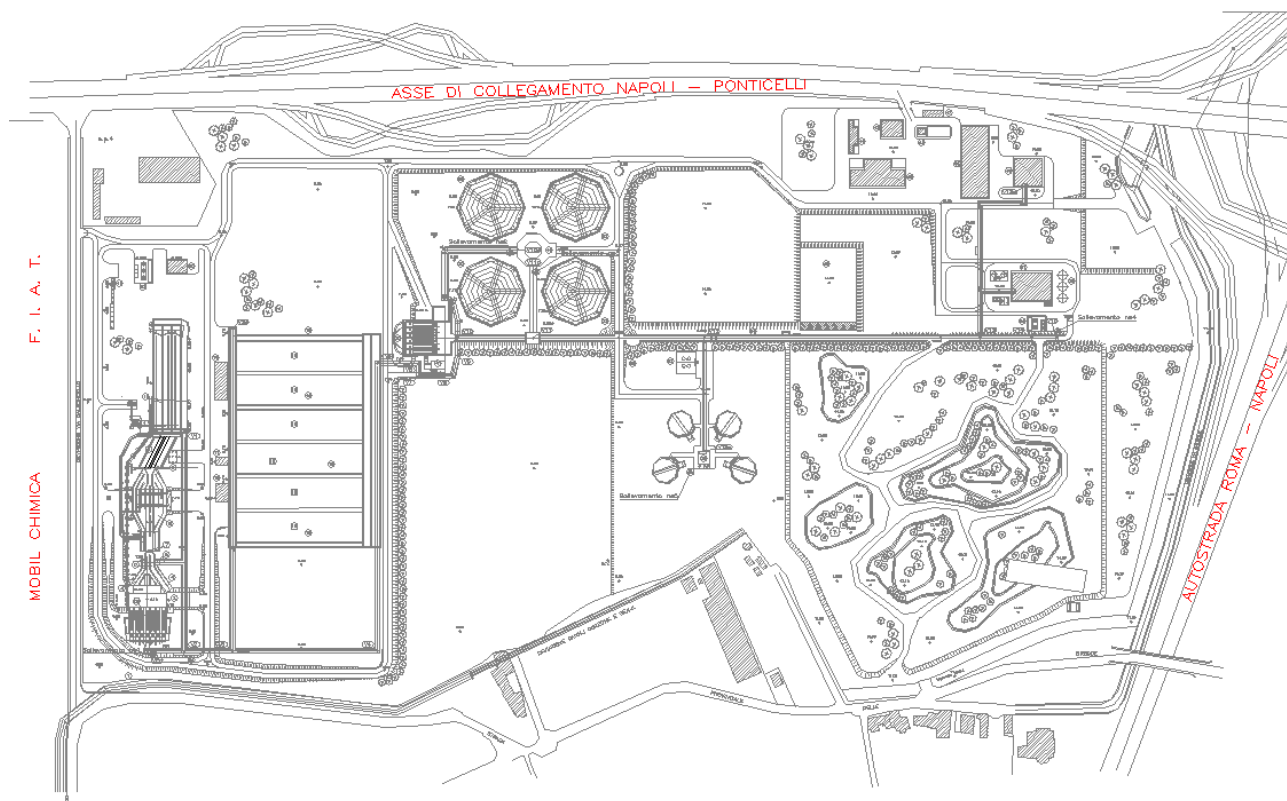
Planimetria generale dell'area dell'impianto di Napoli Est
